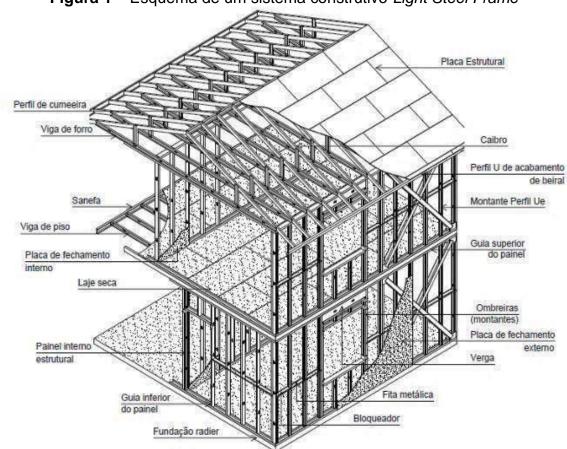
Esquema de um sistema construtivo Light Steel Frame
